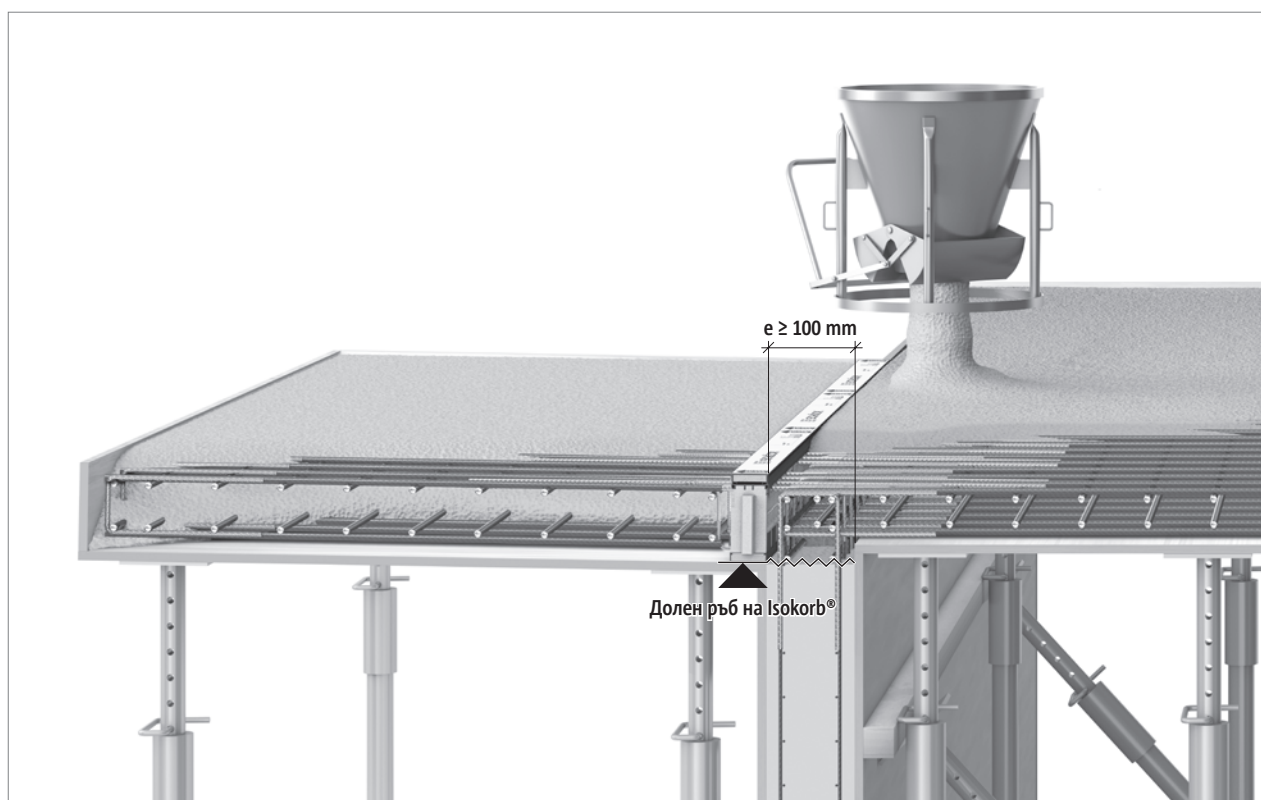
Schöck Isokorb® T тип KL: Подготовка на арматурката за бетониране и поставяне на T тип KL
